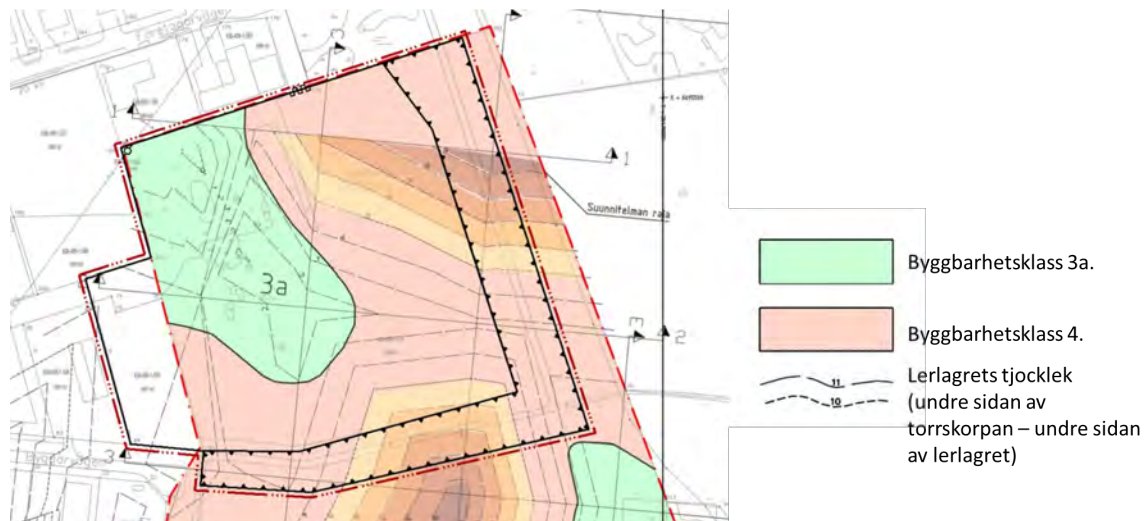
Bygghetsklassen på planeringsområdet enligt markundersökningar.
